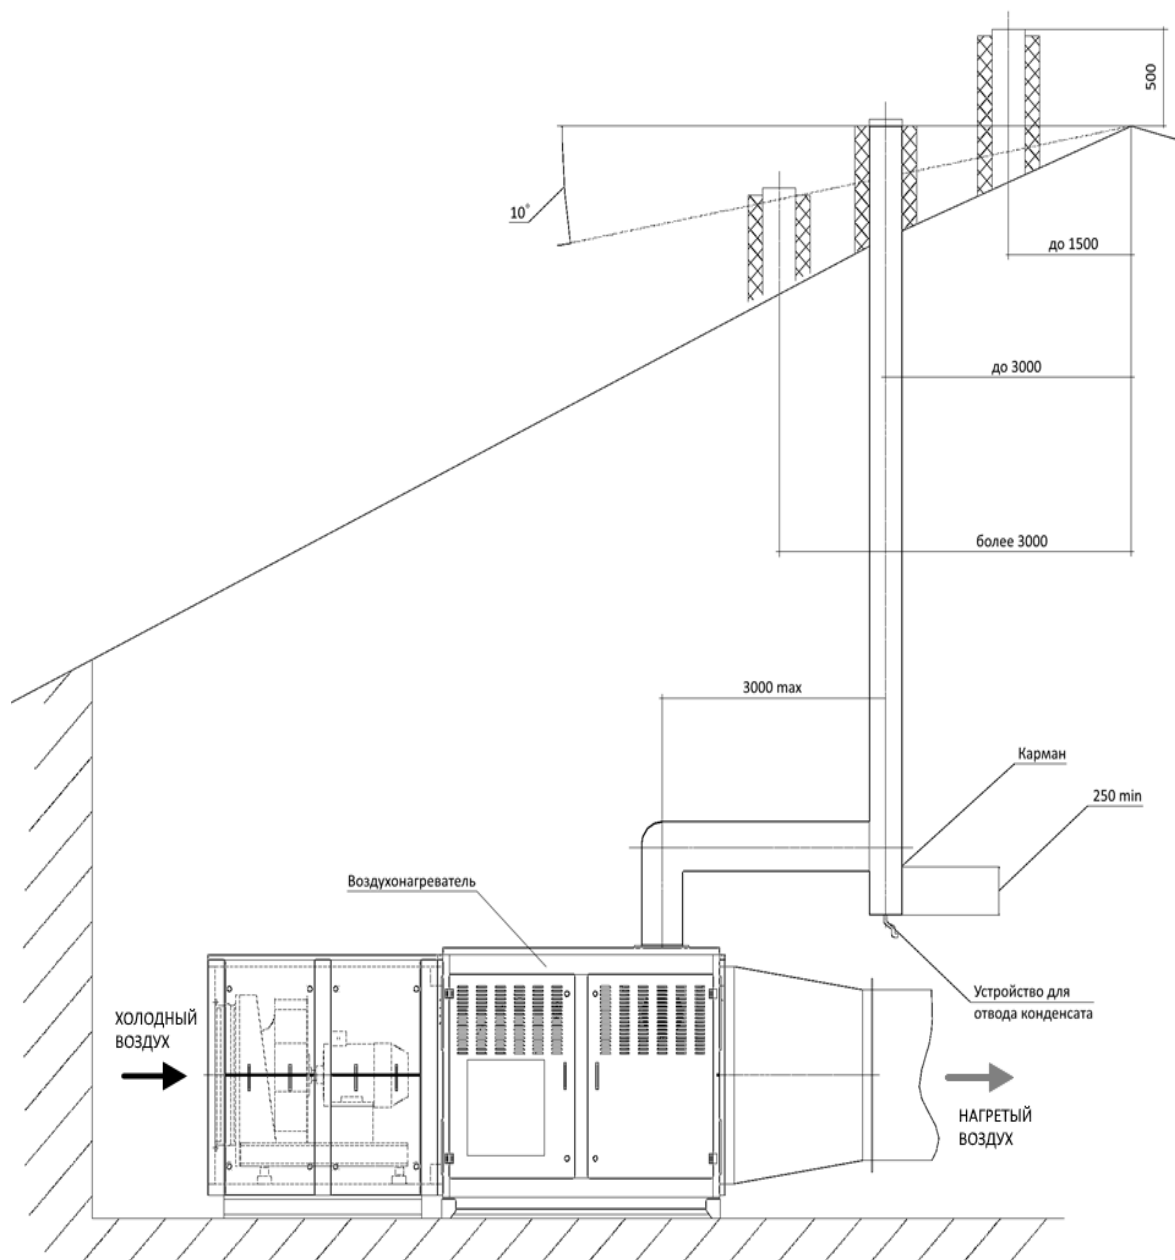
Схема установки дымовой трубы при размещении нагревателя серии НЛ-11 в помещении
